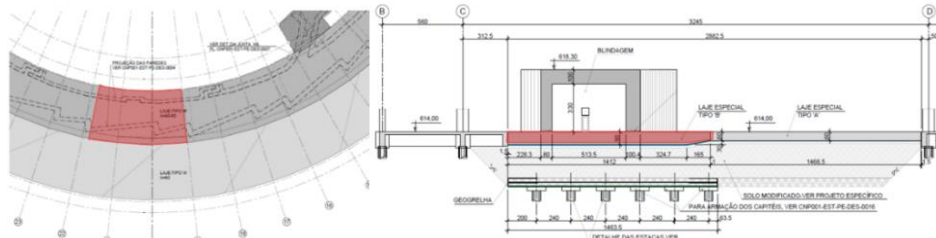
Seção típica do piso tipo B, placas com espessura de 0,90cm (região na cor vermelha indicando a seção modelada) – (a) seção em planta e (b) corte A-A da seção (DESEK, 2016).
